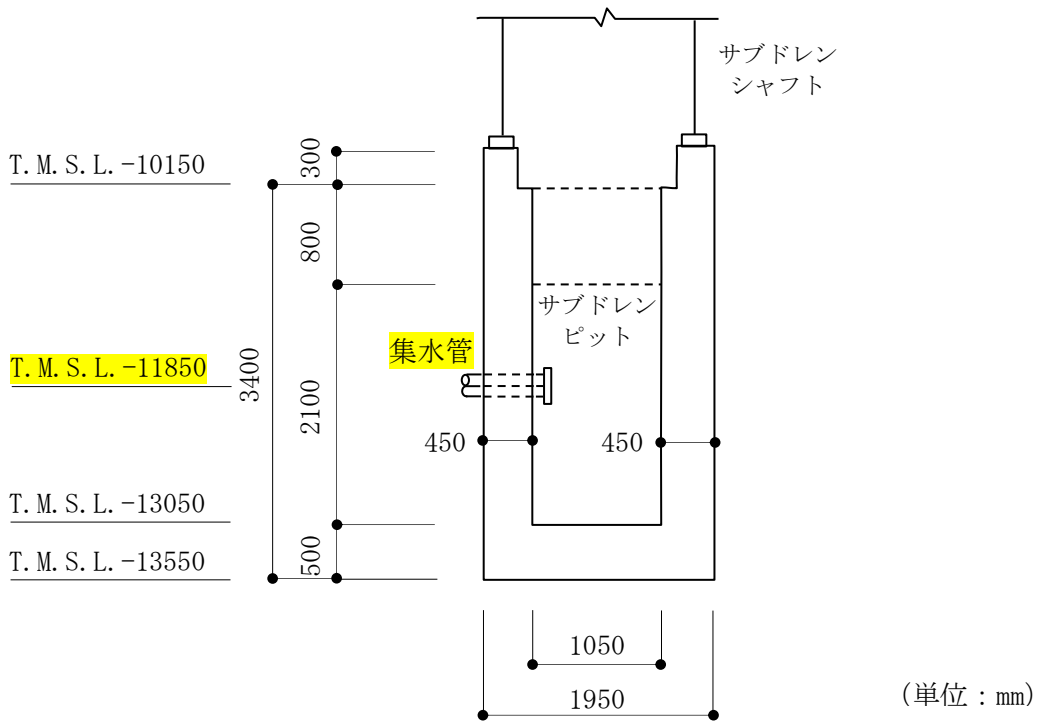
タービン建屋サブドレンピットの概略断面図 (B-B 断面)
